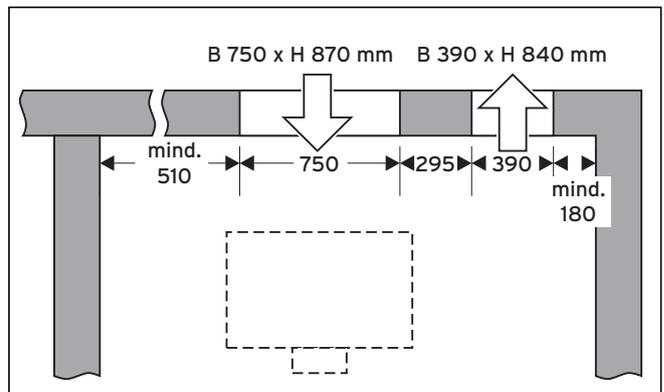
Wand-Installation, Luftaustritt rechts
